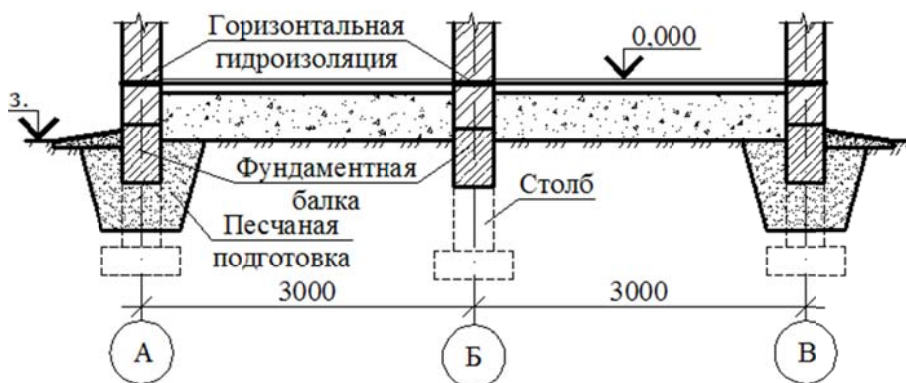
Разрез сборного фундамента с фундаментными балками
